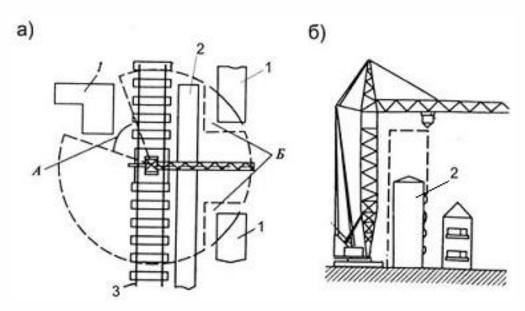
Схема расположения башенного крана на строительной площадке:
